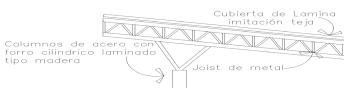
Vigas Joist, columnas de metal y lamina imitación teja como cubierta. Guatemala, 2016.
